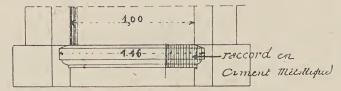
et 71. — Plan et élévation d'un appui en pierre ravalé et restauré en ciment métallique.
